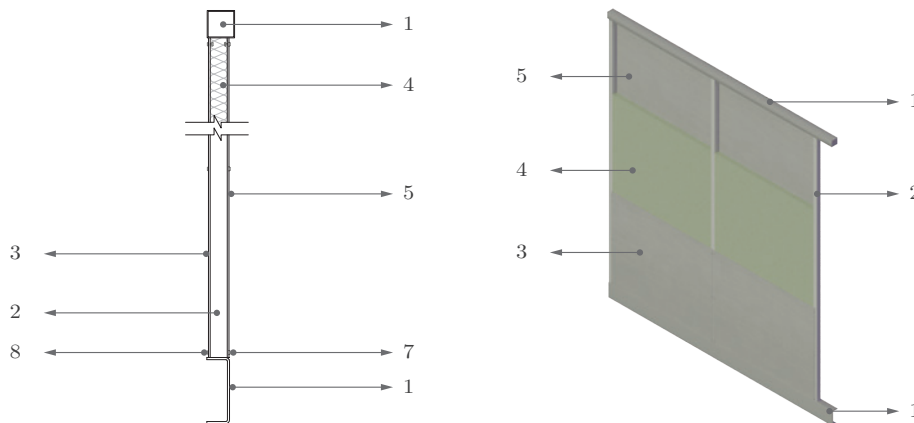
Ampliación D1 de la sección constructiva del habitáculo Emergency Expa Room. Fuente y elaboración: Autores.
